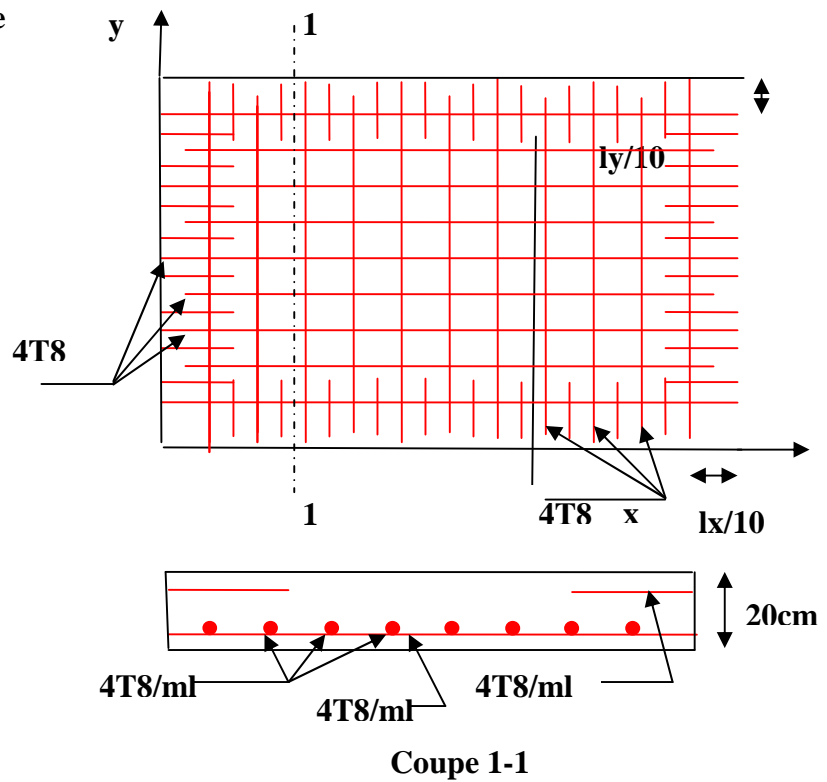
Schéma de ferrailage – dalle du local machine-dalle de la cuvette
